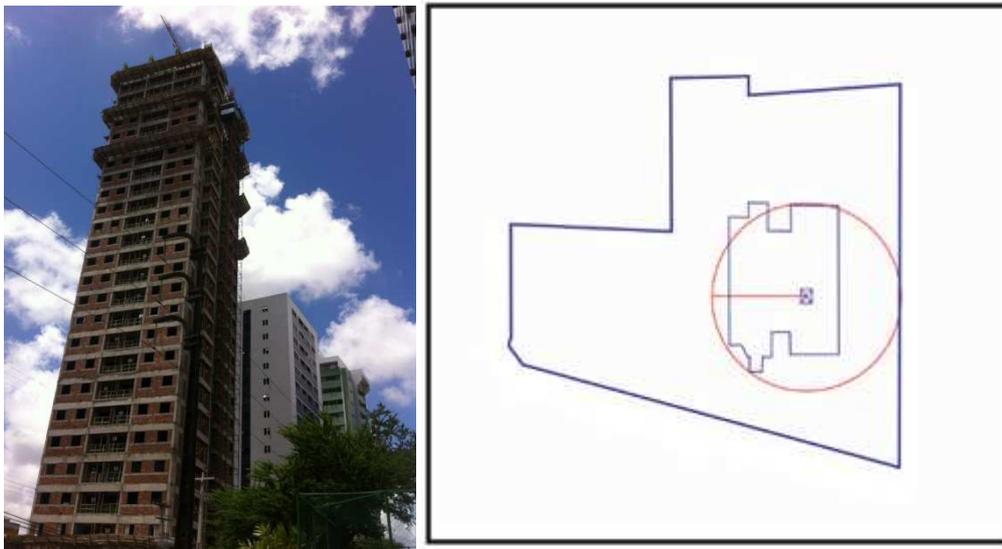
Planta de lay-out do canteiro do projeto VI.
